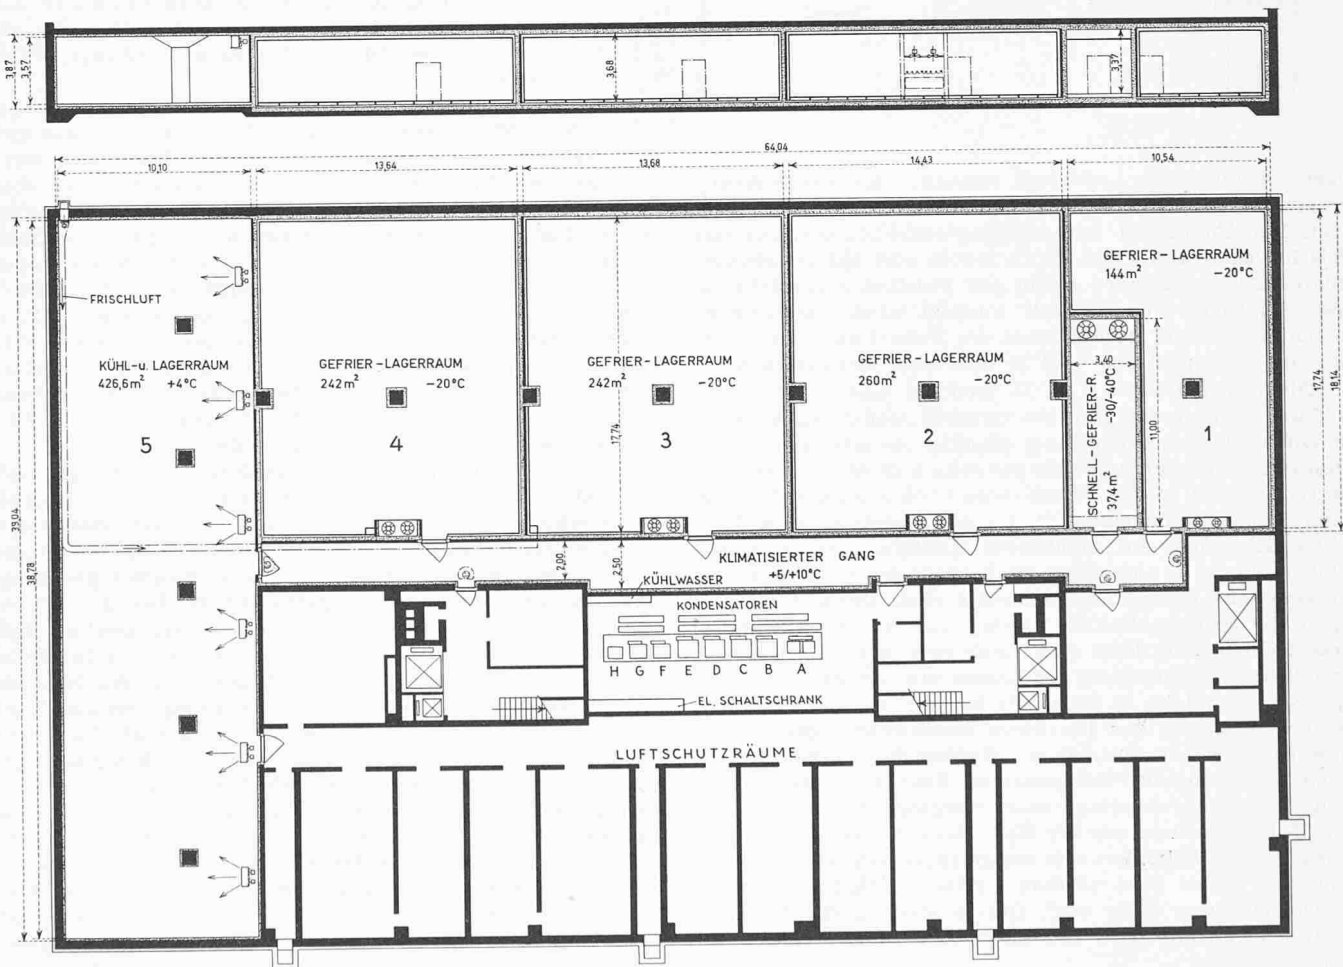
Grundriss und Aufriss der Tiefkühlanlagen im Kellergeschoss des Geschäftshauses «Flüelahof». Ueber die Zuteilung der Maschinen-gruppen A bis H zu den Räumen orientiert Tabelle 1, Seite 103. Masstab 1:400
